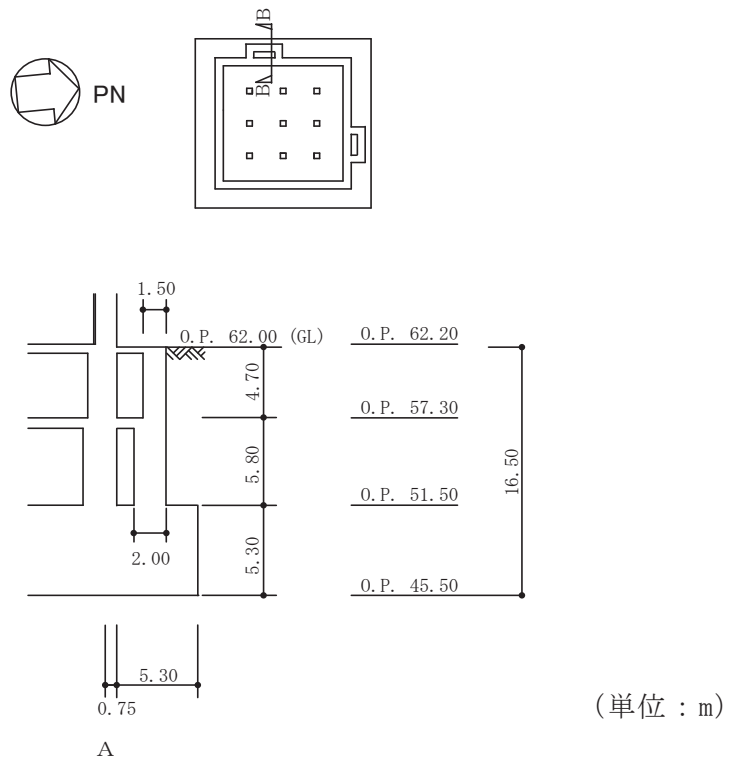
(2) 緊急時対策建屋の概略断面図 (B-B 断面, EW 方向)
